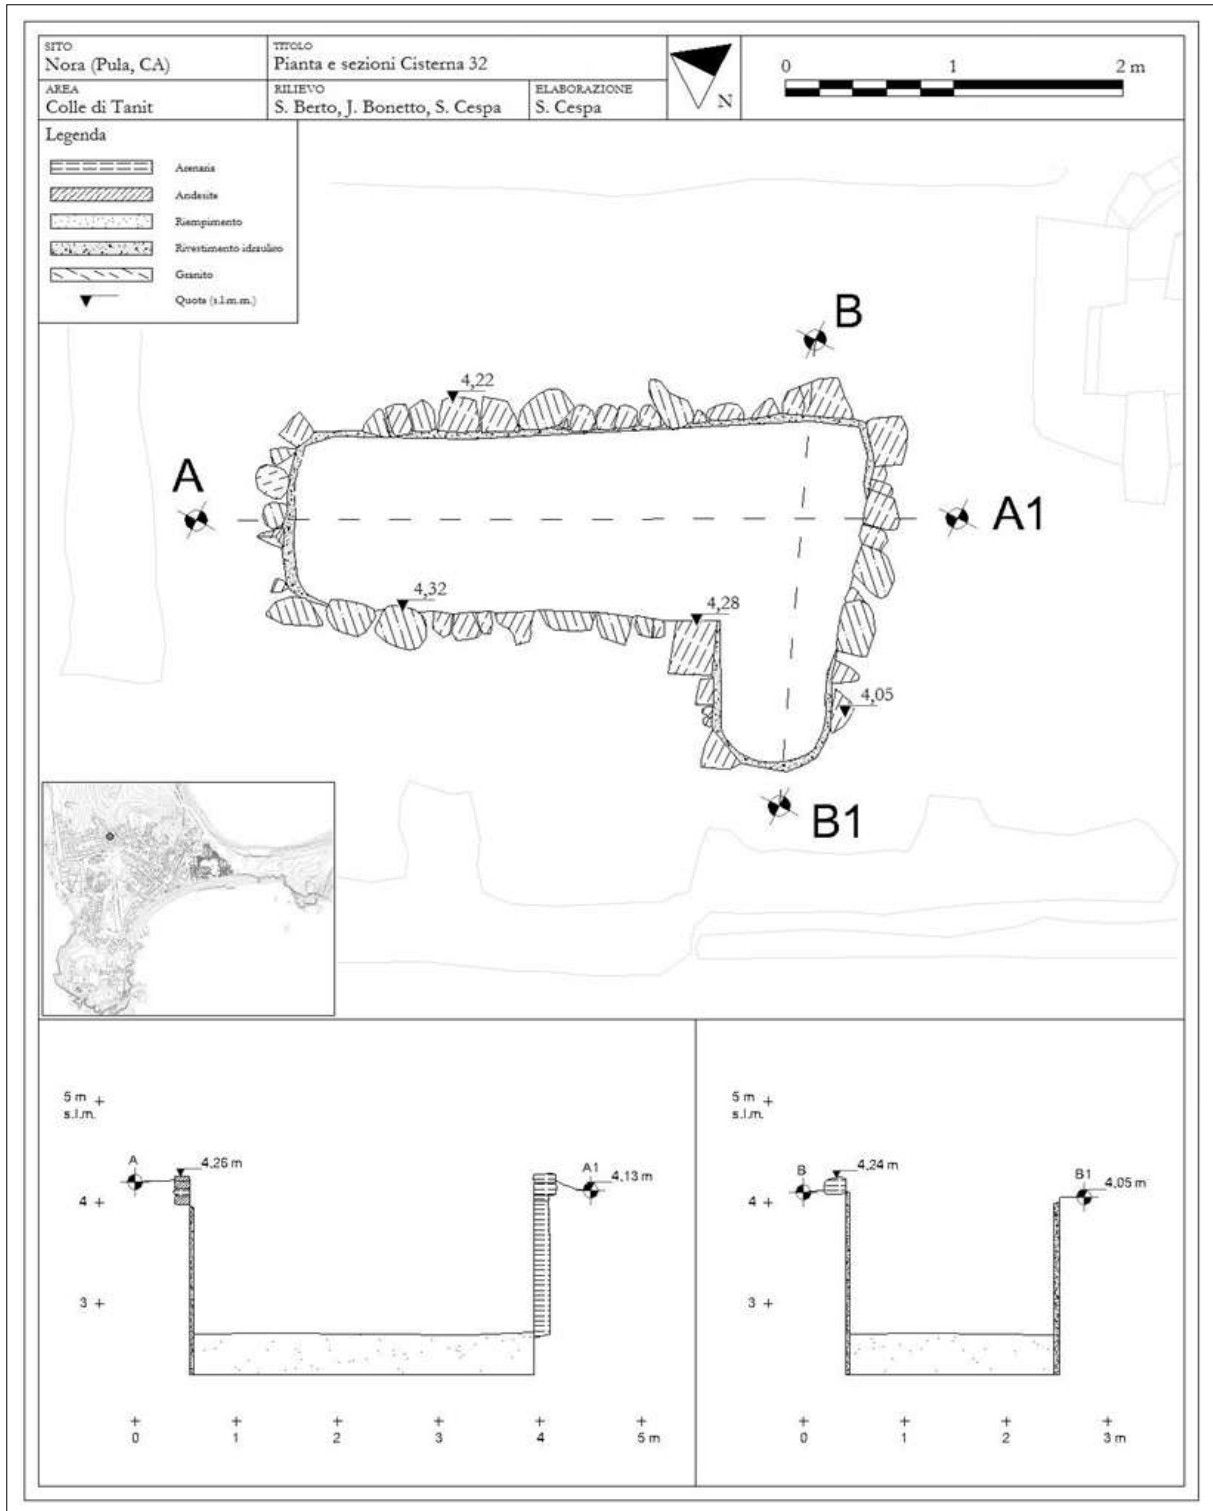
Pianta e sezioni della cisterna 32 (elaborazione dell'autore).
